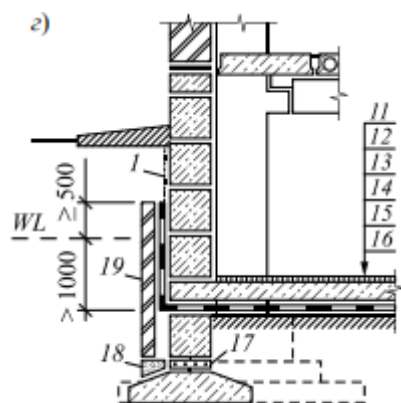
Отдельные фундаменты под железобетонные колонны постоянного сечения для зданий с подвалами: а – в – при УГВ ниже подошвы фундамента, г – при
